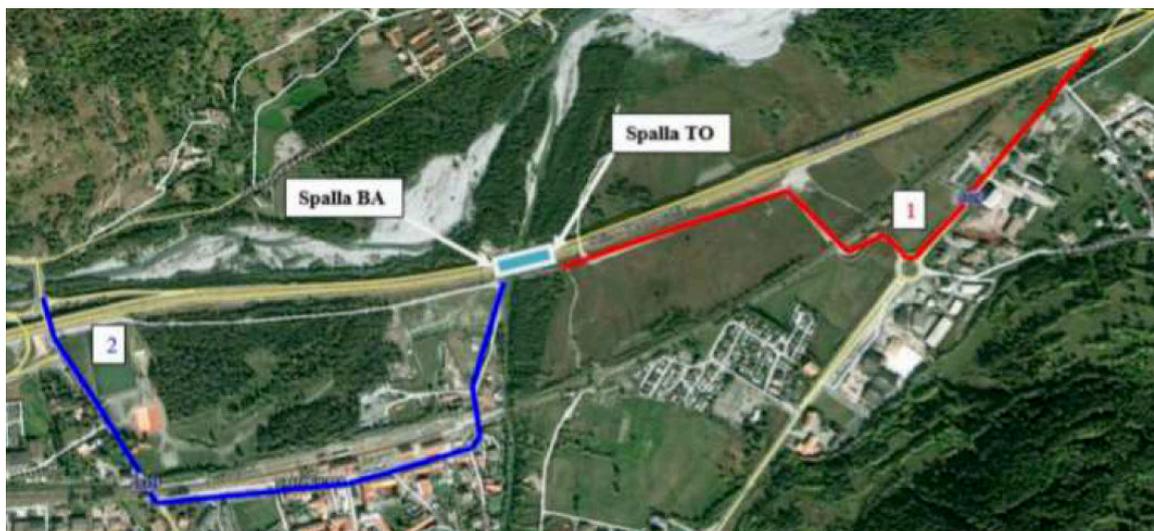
Viabilità di accesso alle aree di cantiere (Fonte: Lista di controllo)
